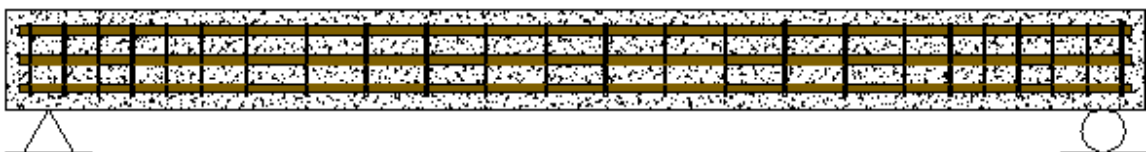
Vigas reforzadas con lata y posibles esquemas de refuerzo
